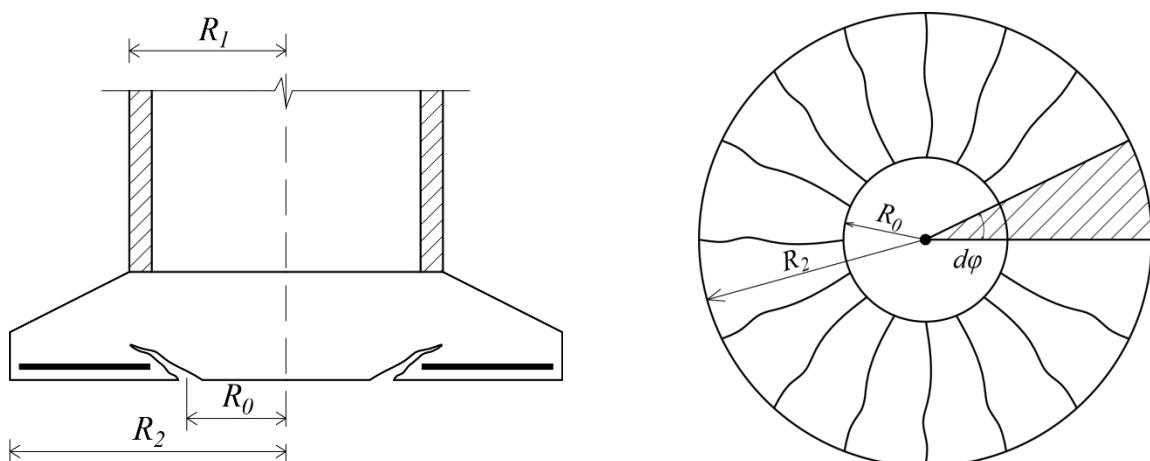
Расчетная схема разрушения фундамента для определения места обрыва стержней нижней арматуры
